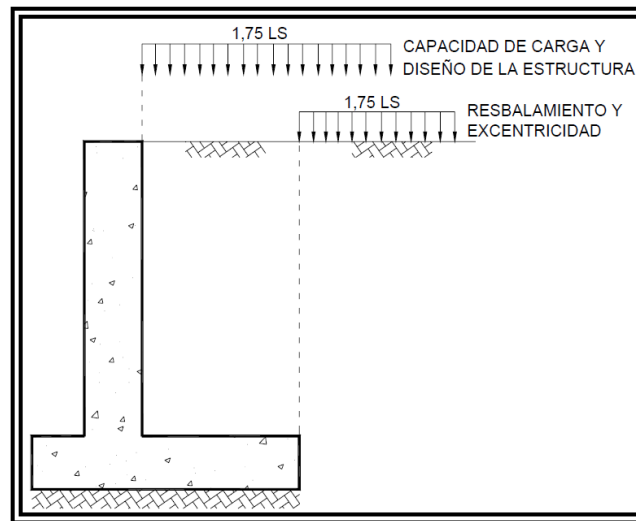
Típica aplicación de las sobrecargas para estructura convencional.²⁸⁵
